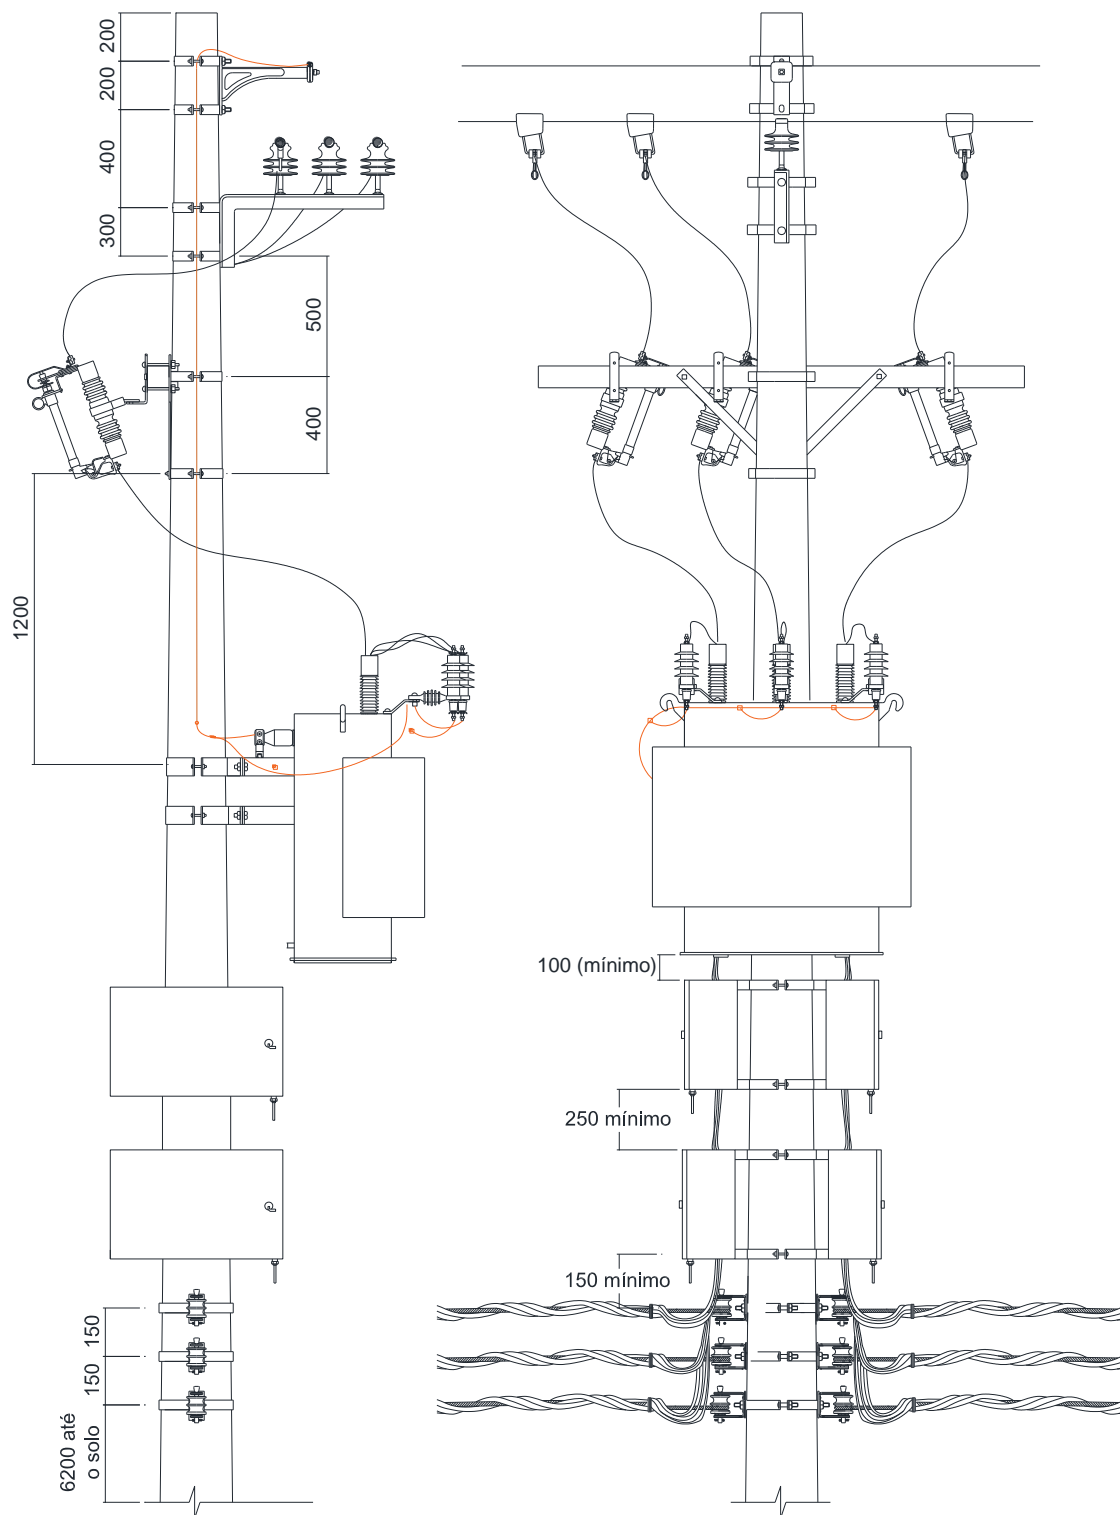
Afastamentos mínimos para estrutura de transformador com caixas de medição
